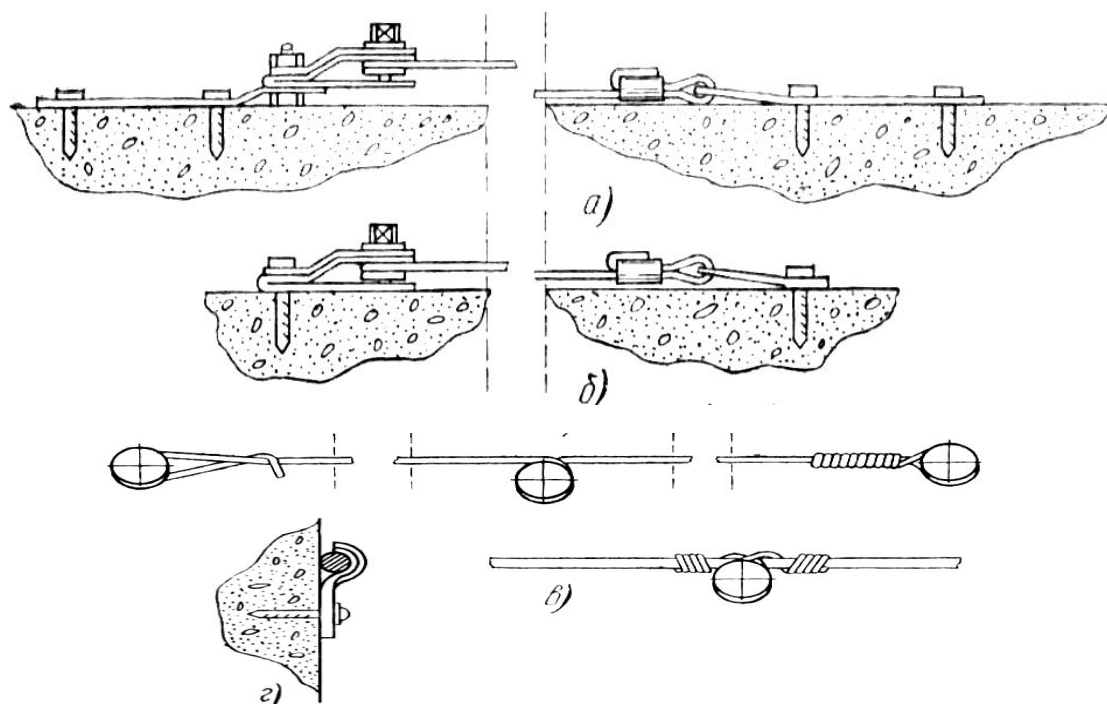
Концевые и промежуточные крепления струн: а – крепление с натяжными приспособлениями; б – крепление без натяжного приспособления с помощью дюбелей; в – варианты креплений непосредственно на дюбелях; г – промежуточное крепление струны при помощи скоб
